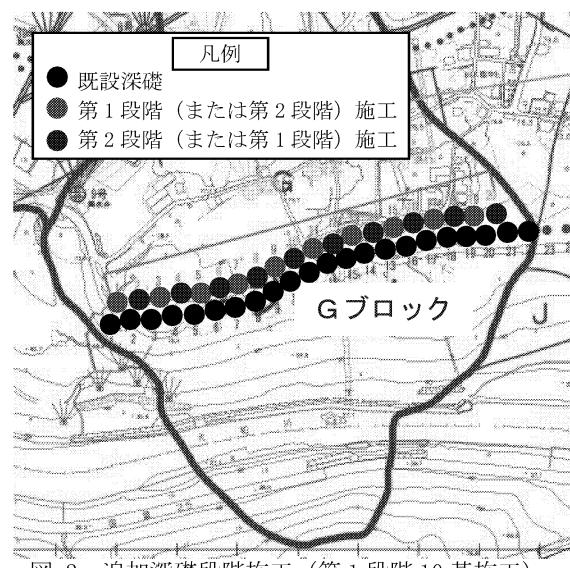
追加深礎段階施工（第 1 段階 10 基施工）
